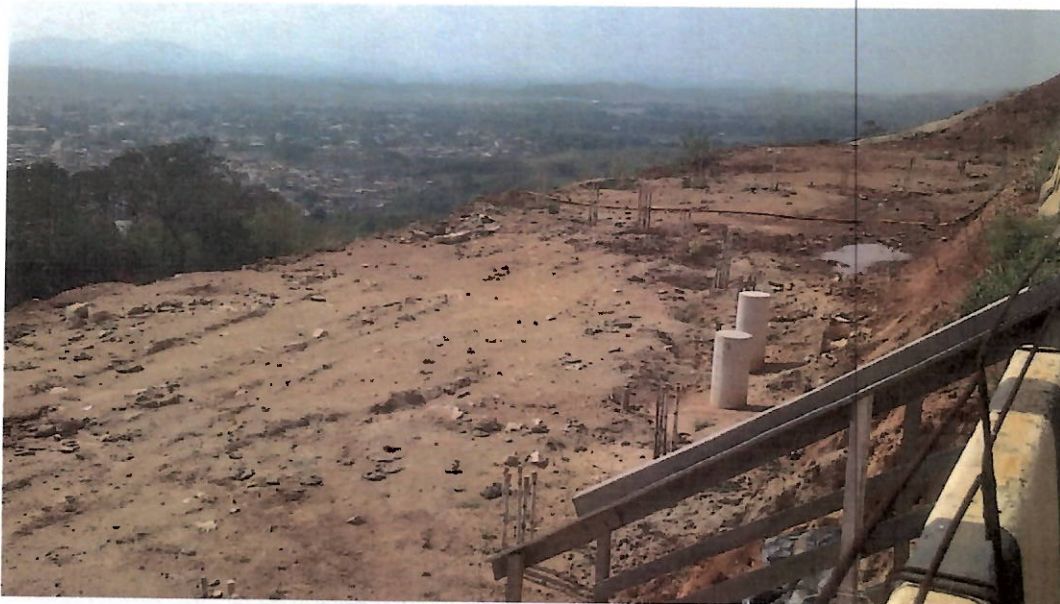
Novo Marapicu: obra de terraplanagem e colocação de estacas para construção do reservatório.
